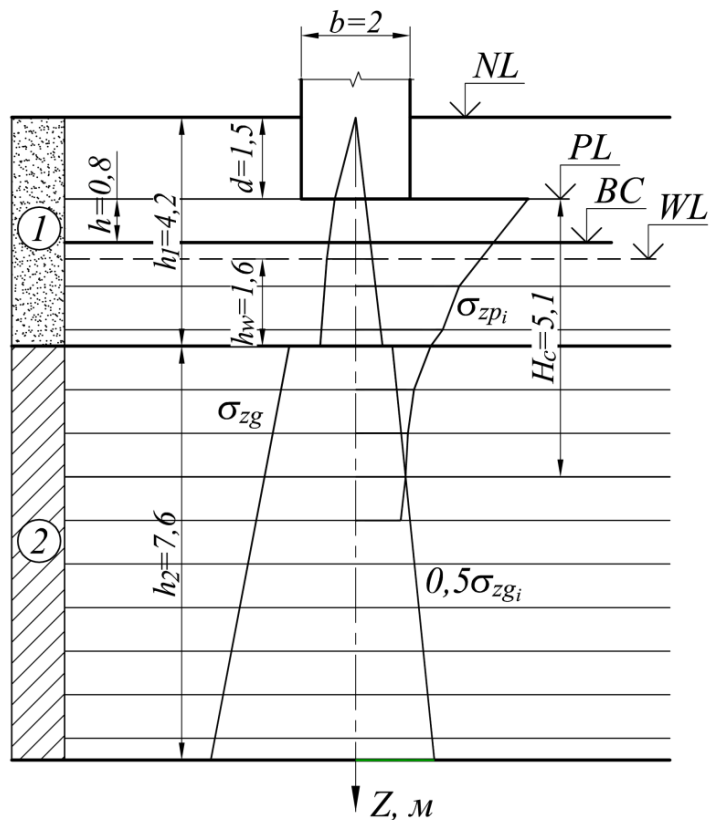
Эпюры вертикальных напряжений от собственного веса грунта и нагрузки от фундамента: 1 – песчаный грунт; 2 – глина
